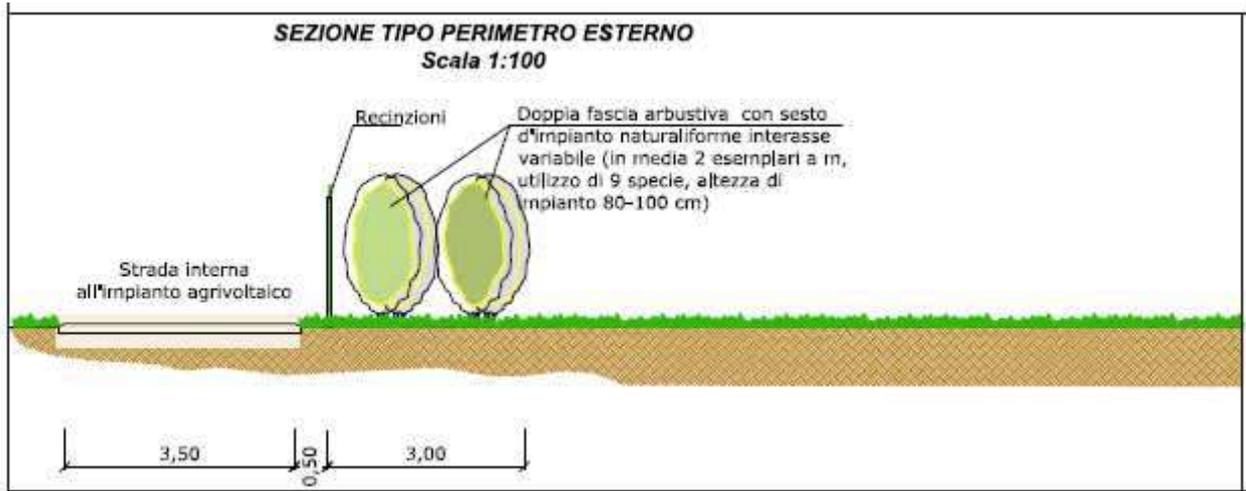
Sezione tipo della pista perimetrale (Fonte: stralcio Elaborato T22)
